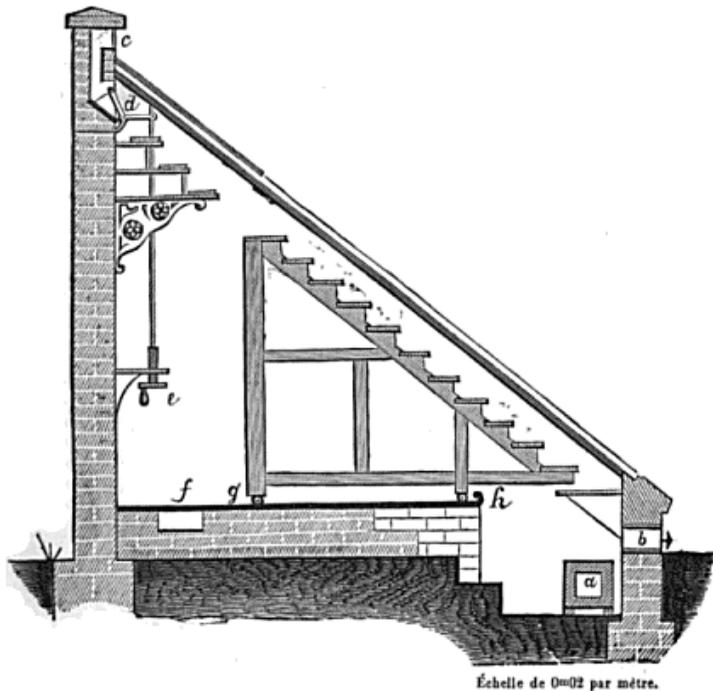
Serre à gradins mobiles pour la culture forcée du fraisier.
